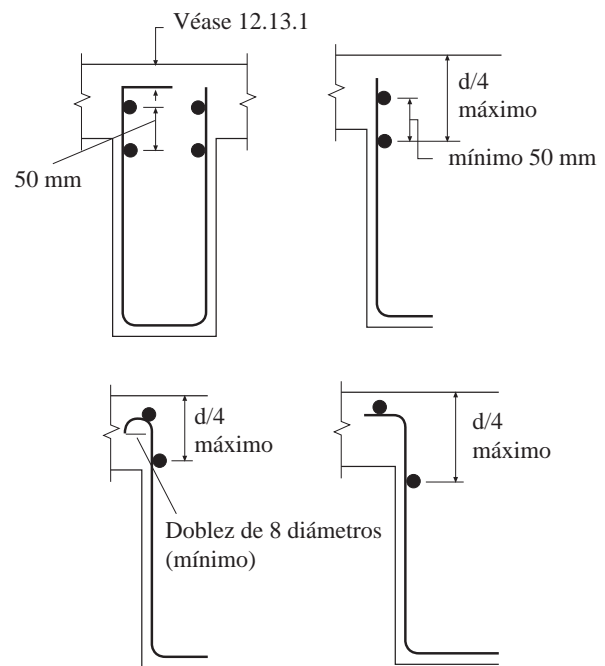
Anclajes de estribos U de malla electrosoldada de alambre liso en la zona de compresión.
